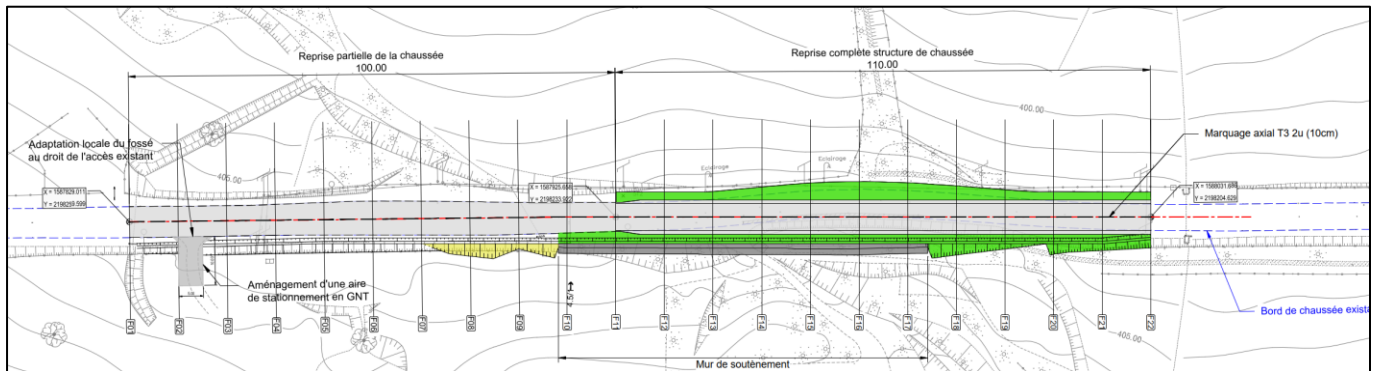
vue en plan, reprise totale structure de chaussée sur 110m, reprise de la couche de roulement sur 100m
